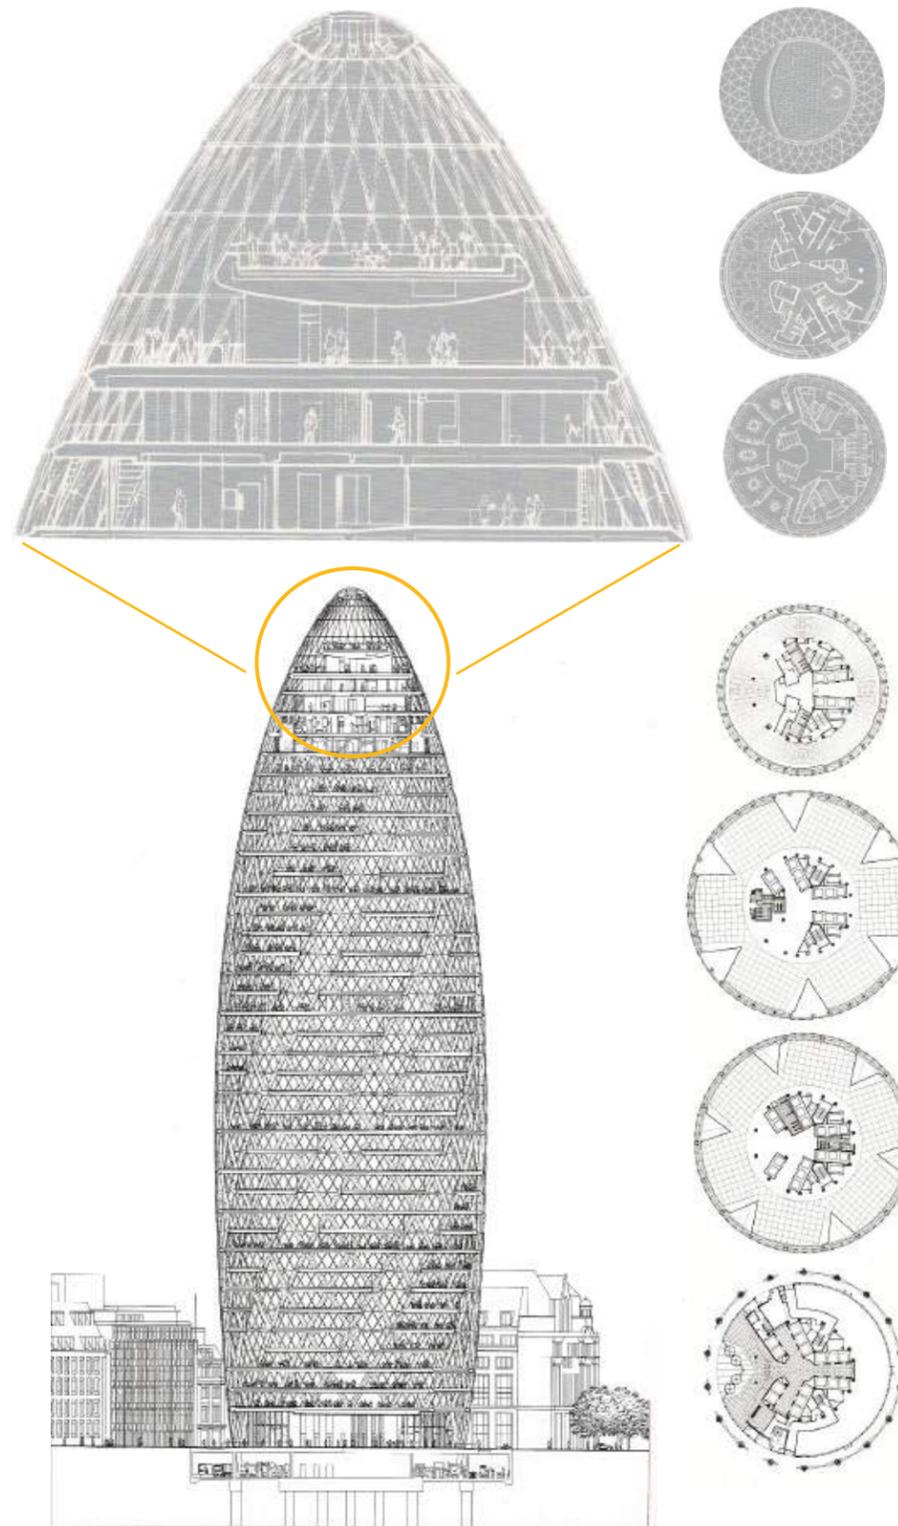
, Coupe transversale avec en partie haute, le dôme (à gauche) et les plans du rez-de-chaussée, du 6e étage, 21e étage, 33e étage, 38e étage, 39e étage et 40e étage (à droite, de bas en haut), tirées de 30 St Mary Axe A Tower for London, 2006
